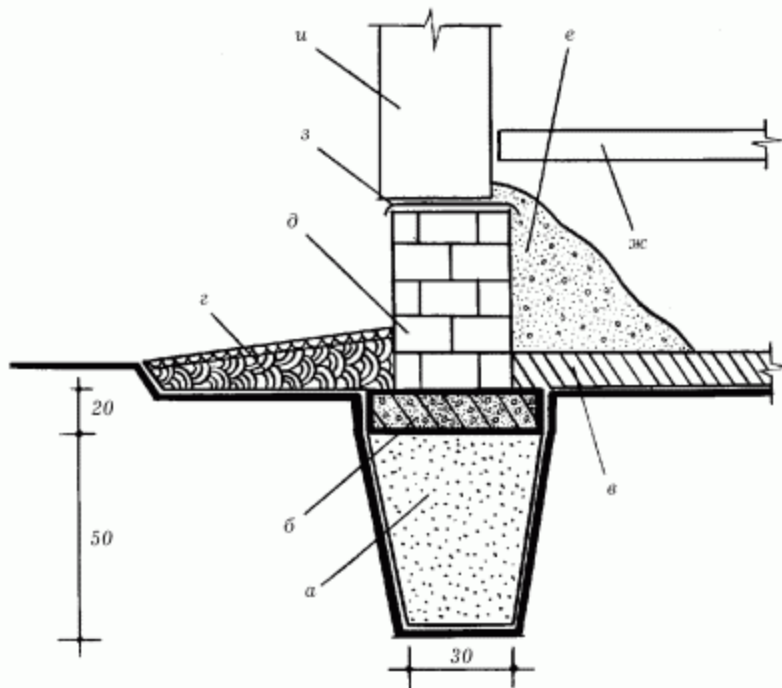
Устройство песчаного фундамента: а – крупнозернистый песок; б – бетон; в – уплотненный грунт; г – отмостка; д – цоколь; е – засыпка; ж – пол; з – гидроизоляция; и – стена.
